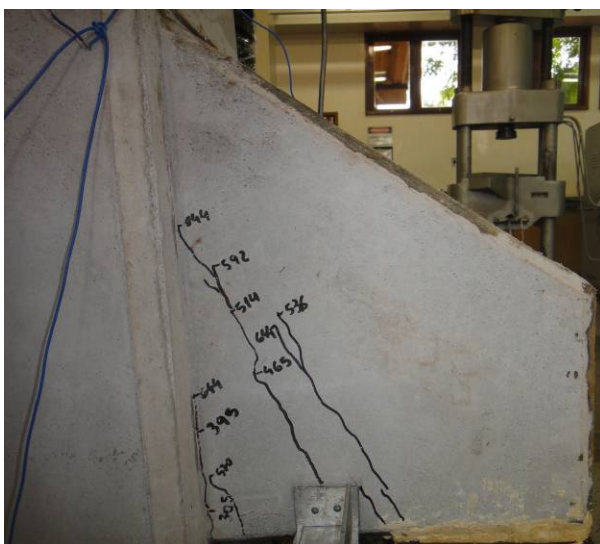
Panorama de fissuração do modelo monolítico M3B
